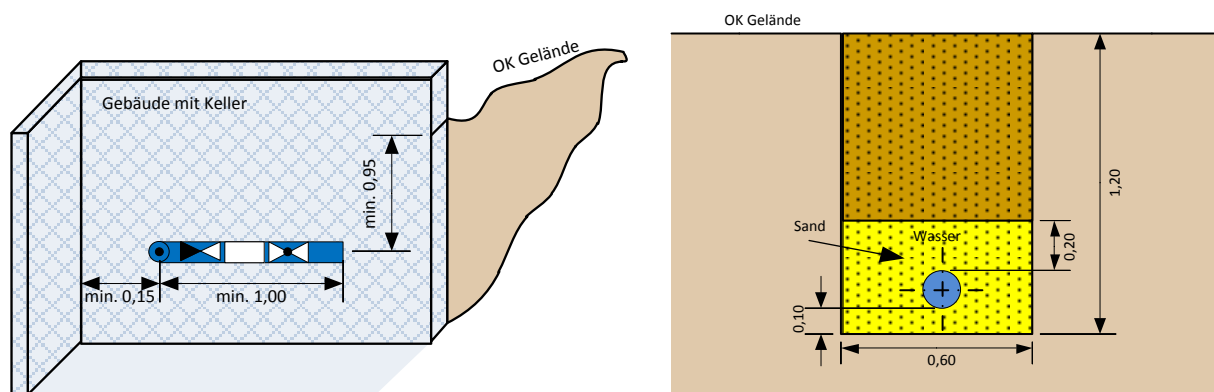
links: Hauseinführungsstelle / Mauerdurchführung,
